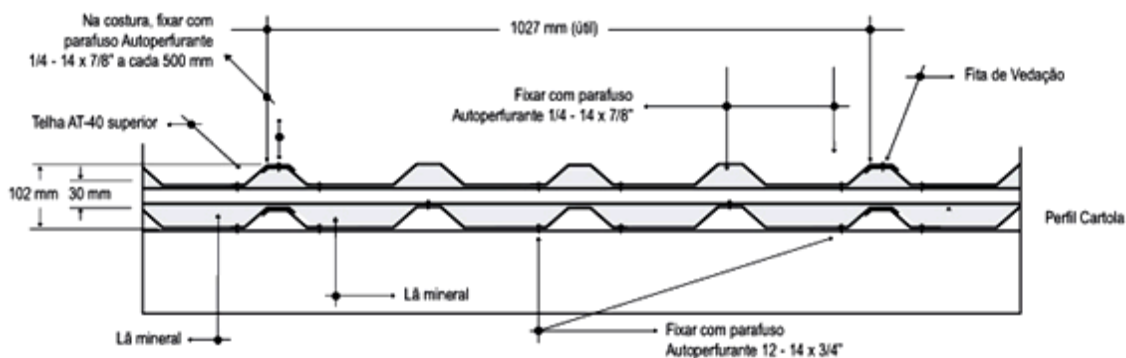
Detalhe da telha com isolamento em lâ mineral
